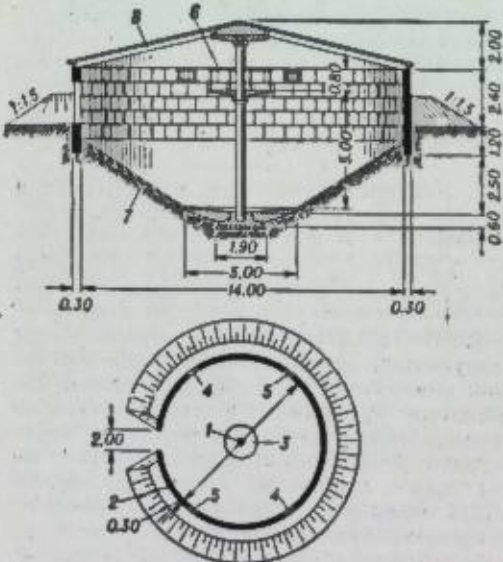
Отдельно стоящая емкость на 500 т (СССР): 1 — железобетонная стойка; 2 — стенка из бетонных стеновых блоков; 3 — железобетонная площадка для зерноульта; 4 — окна; 5 — жалюзиные решетки; 6 — площадка с ограждением; 7 — днище-пол (цементная стяжка, подготовка из кирпичного щебня с проливкой раствором); 8 — покрытие из железобетонных сборных панелей.
